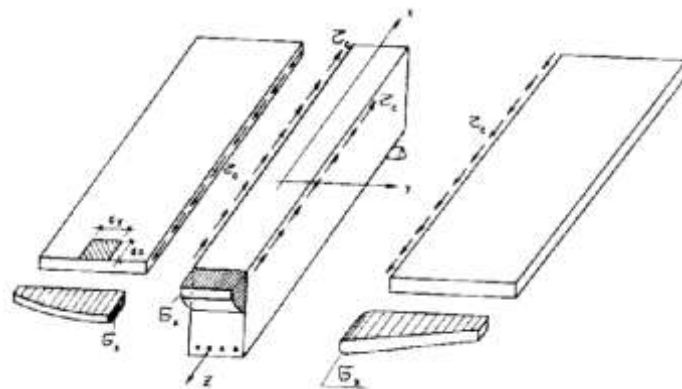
a Transmissão de compressão da viga para a laje.
